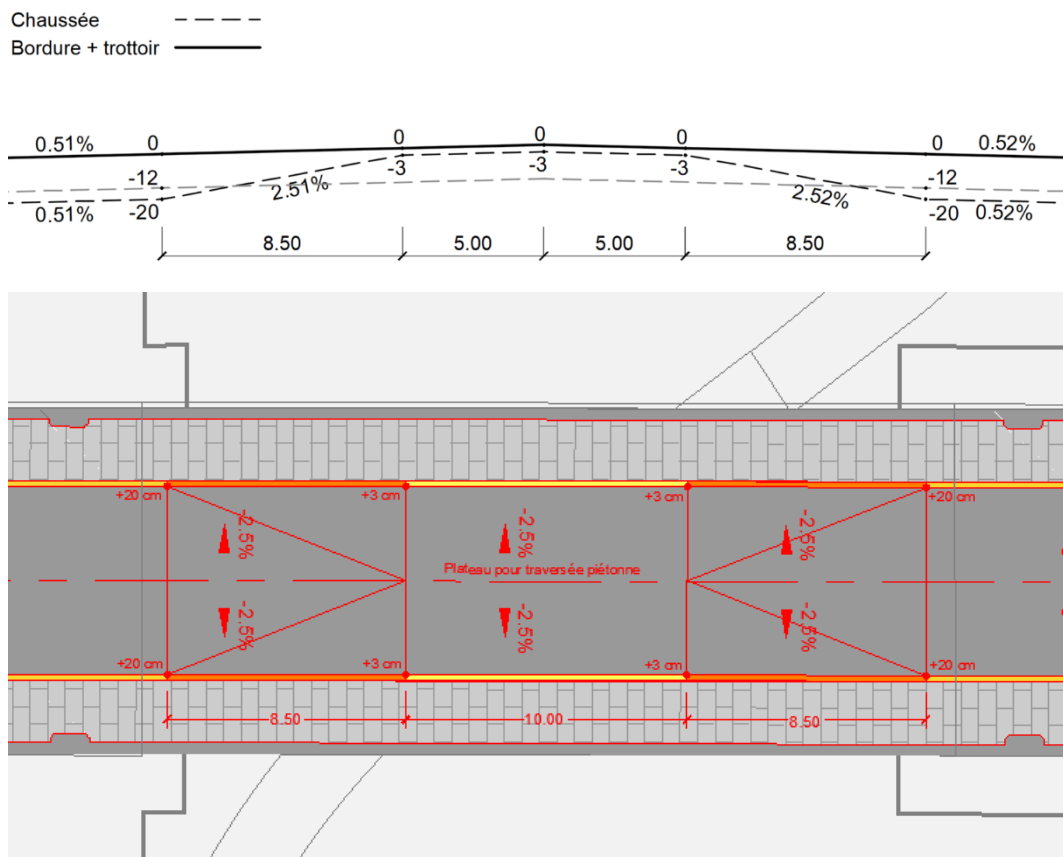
coupe et travaux sur le rehaussement de la route (Source : Buchs&Plumey)
